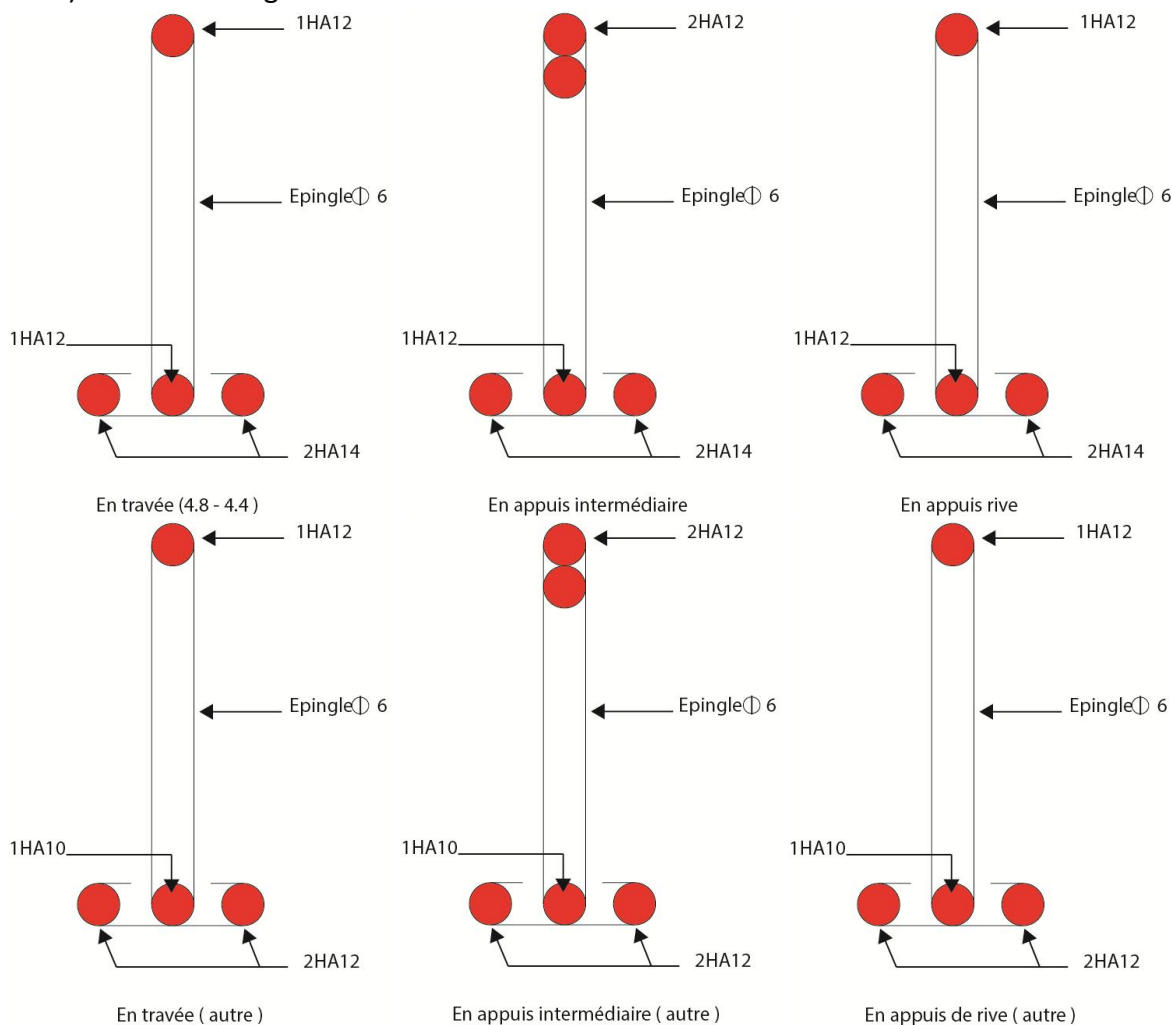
Schéma de ferrailage des poutrelles étage courant.
